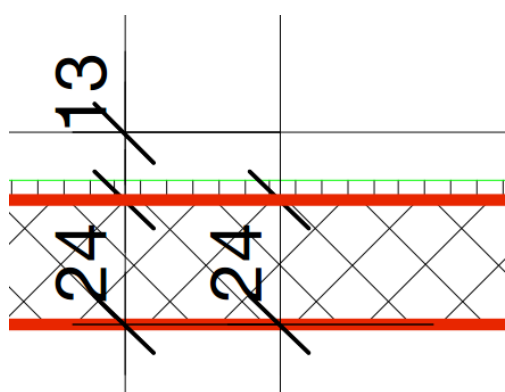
Bodenaufbau BGH-Gebäudeteil
